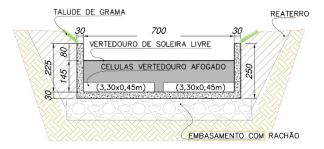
Seção transversal do vertedouro projetado em concreto armado (medidas em cm)
